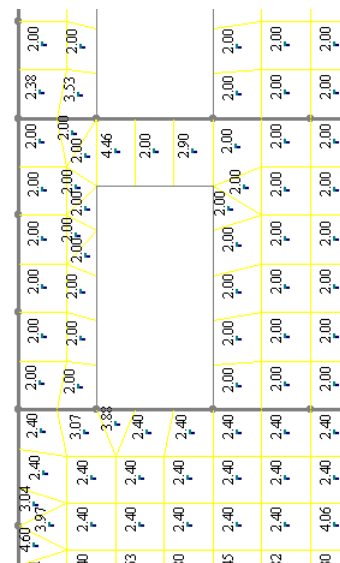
Расчетное армирование стены в графическом и цифровом виде (фрагмент)
